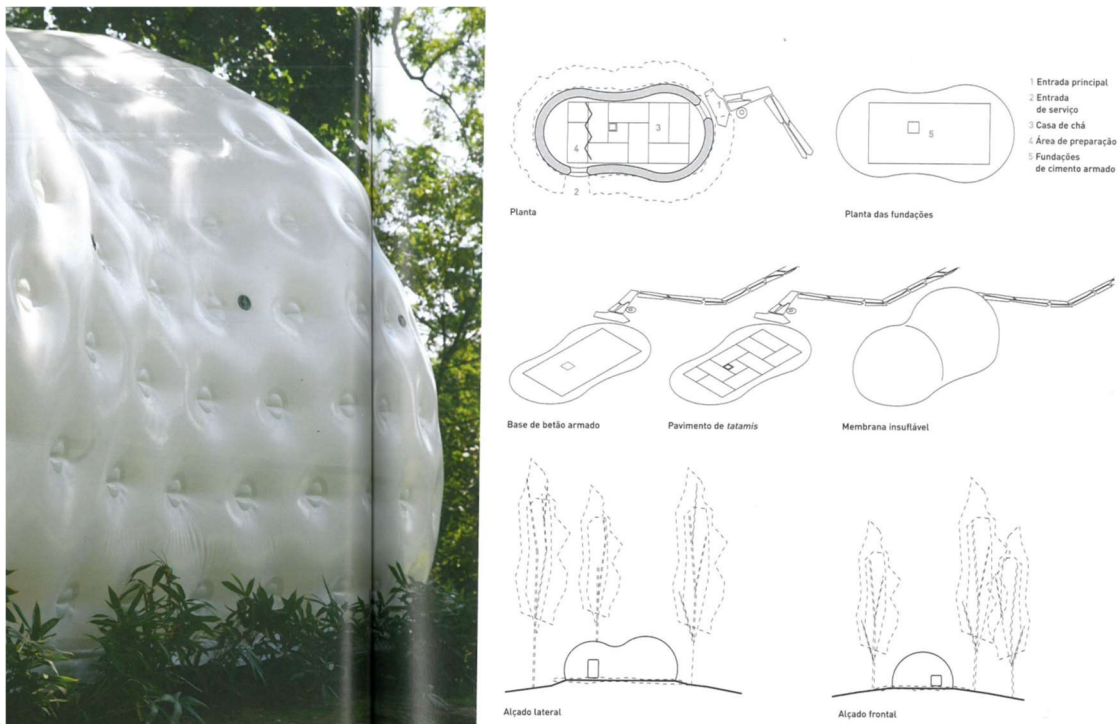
Casa do Chá, vista geral, plantas e alçados, Frankfurt (Bahamón 2008)
